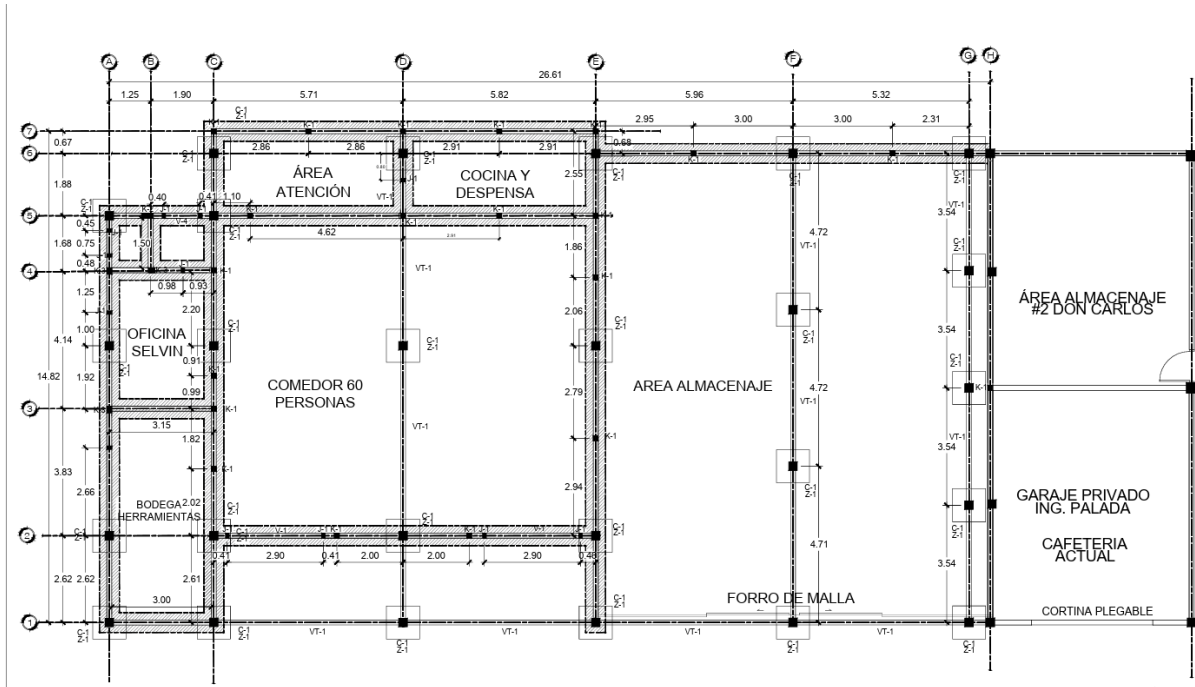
Plano de cimentación de comedor y bodega de almacenaje
